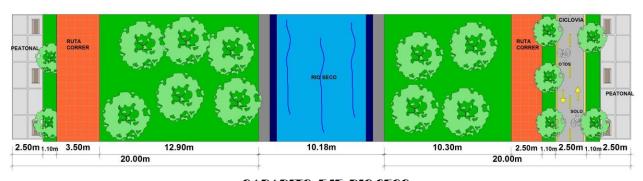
DETALLES DE CORREDOR RIO SECO.
